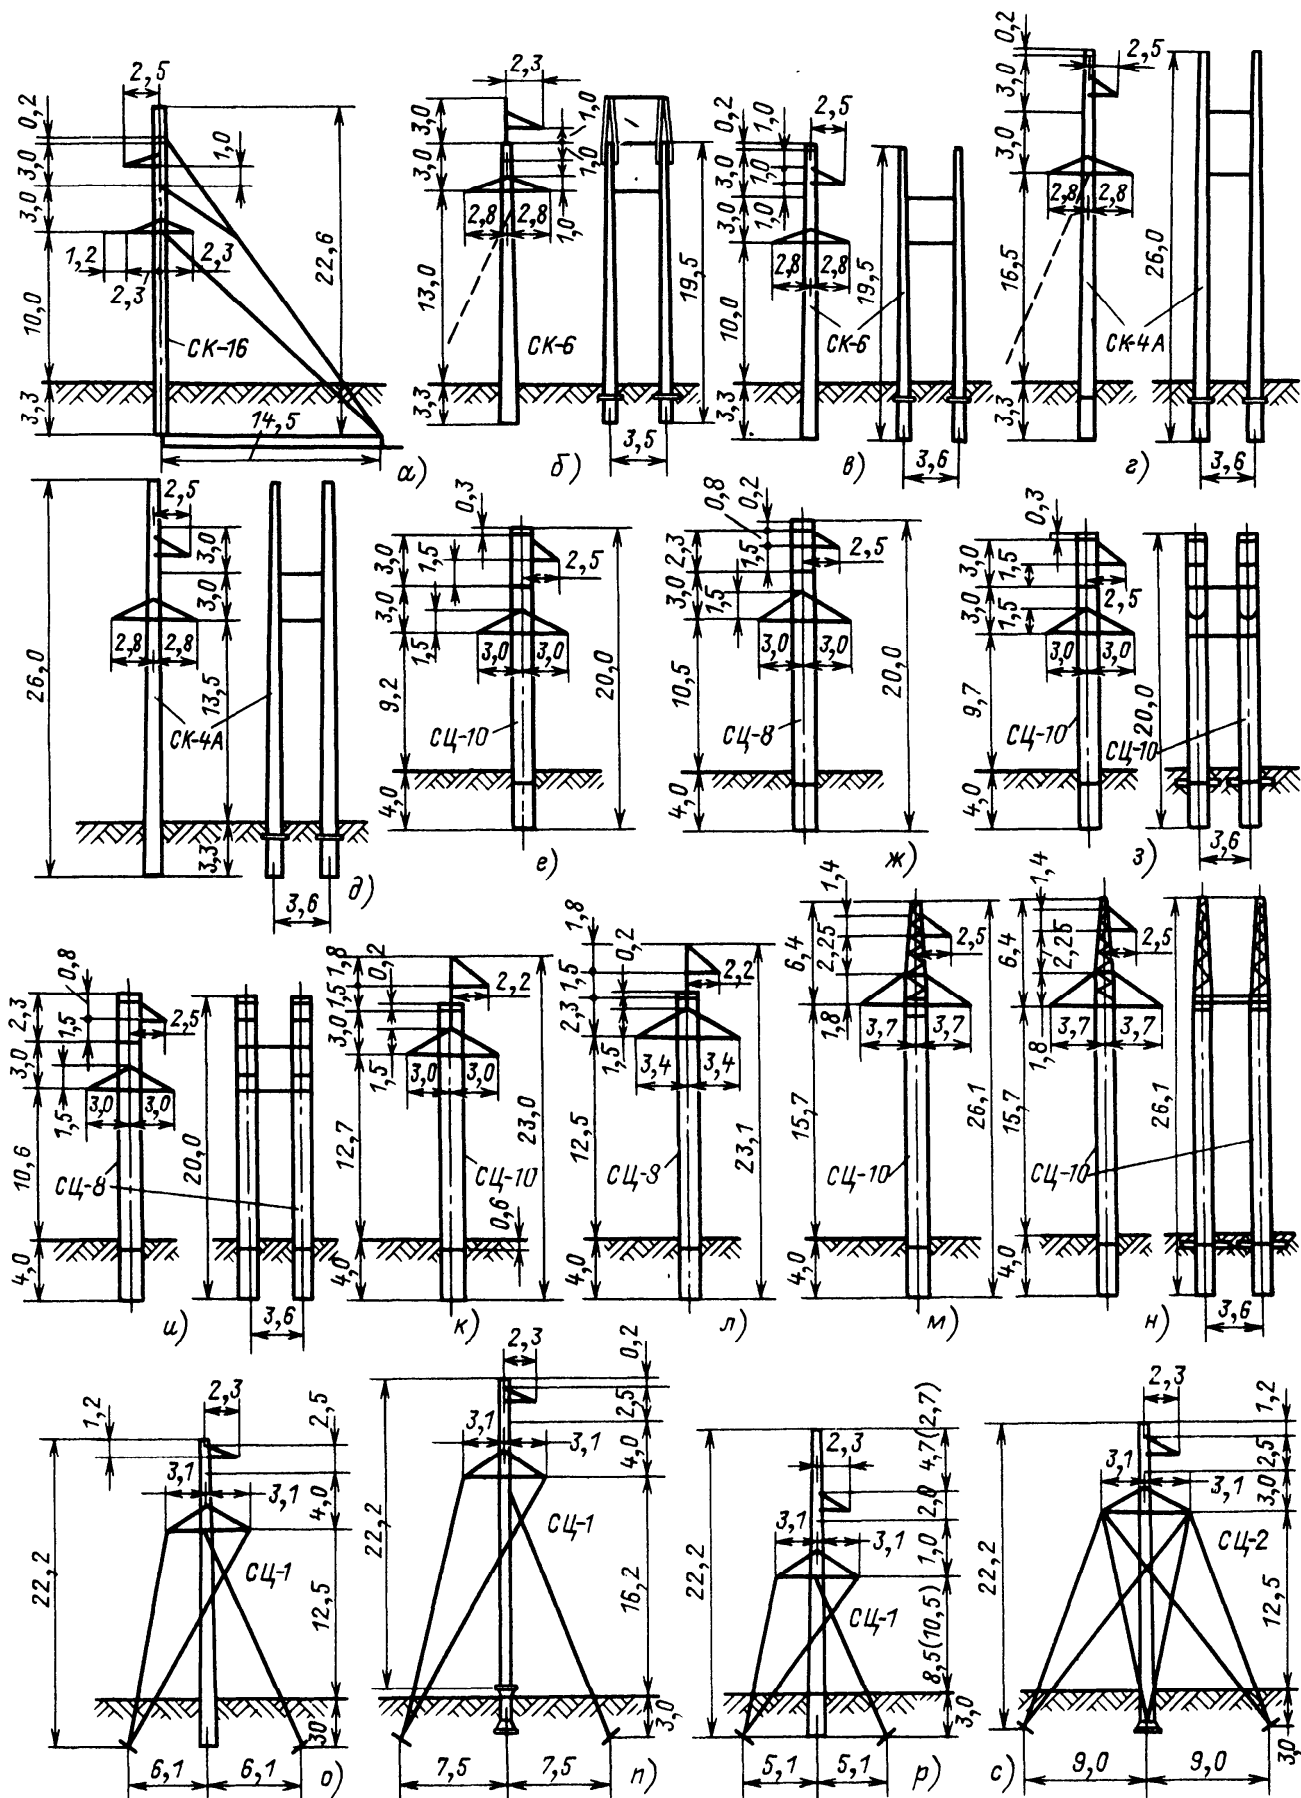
Унифицированные и типовые анкерные угловые железобетонные опоры 110 кВ
